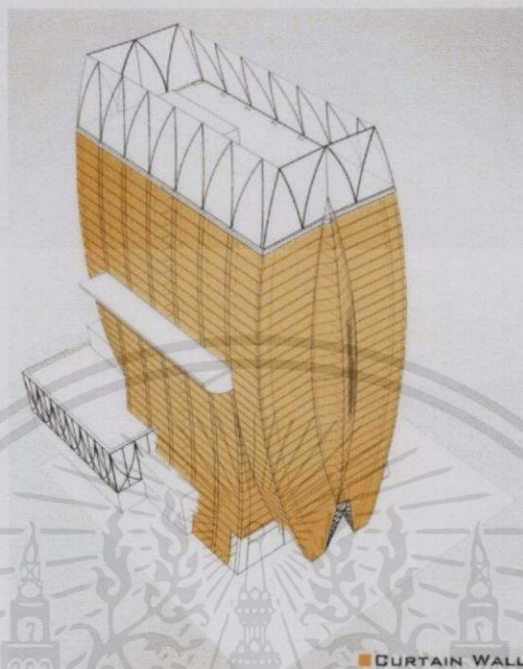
แสดงตำแหน่ง Structure Glass wall ในโครงการ
